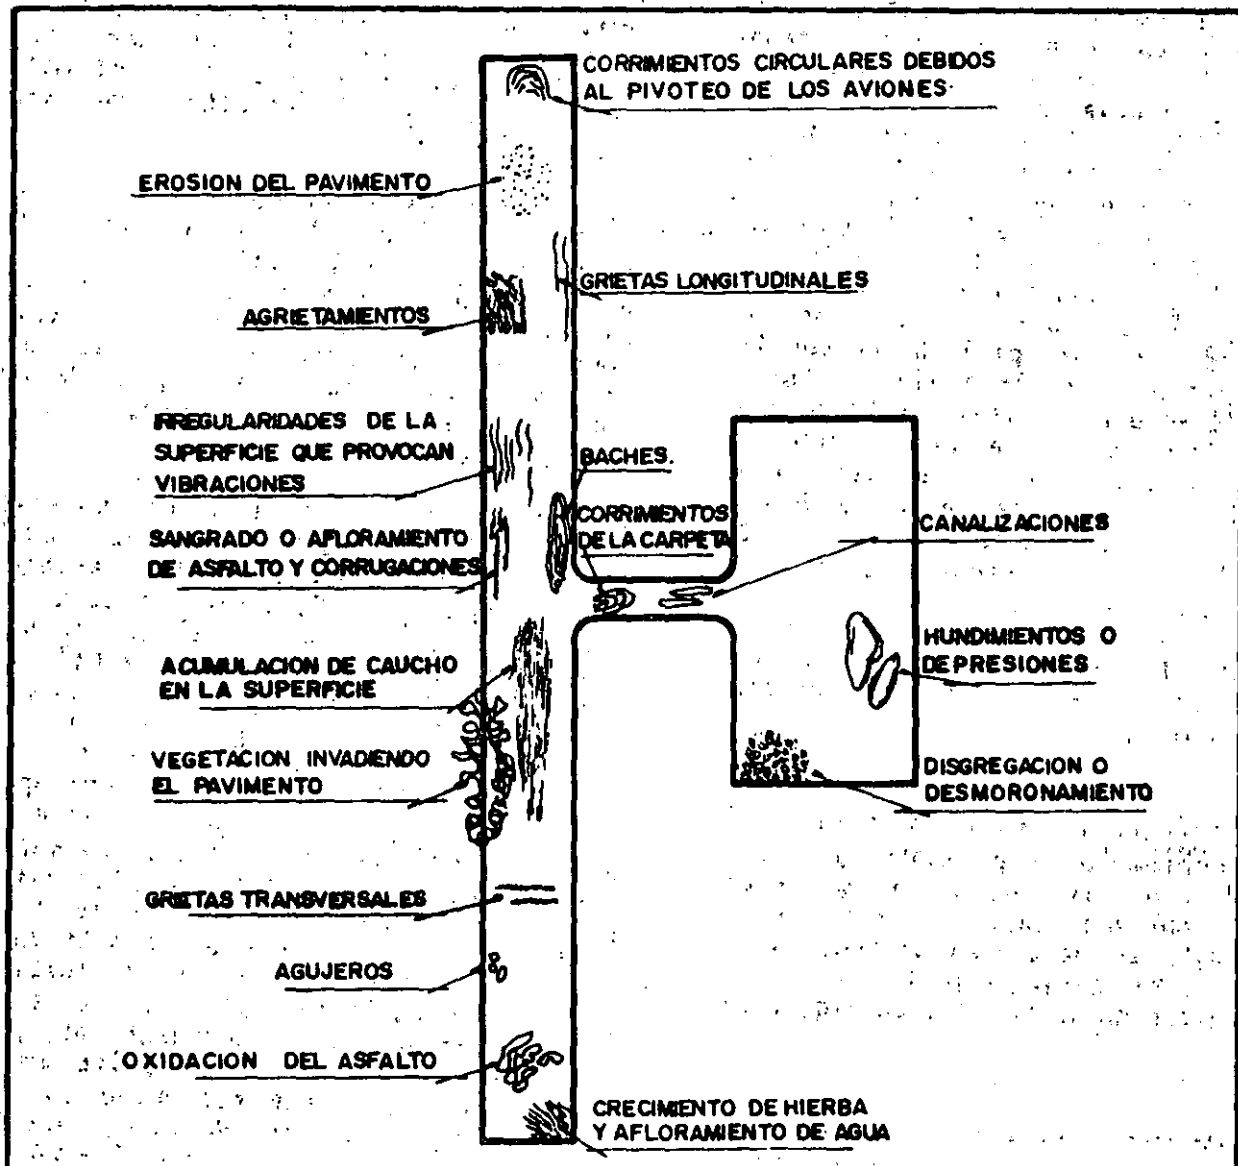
Conservación y detalles a observar en pavimentos flexibles
